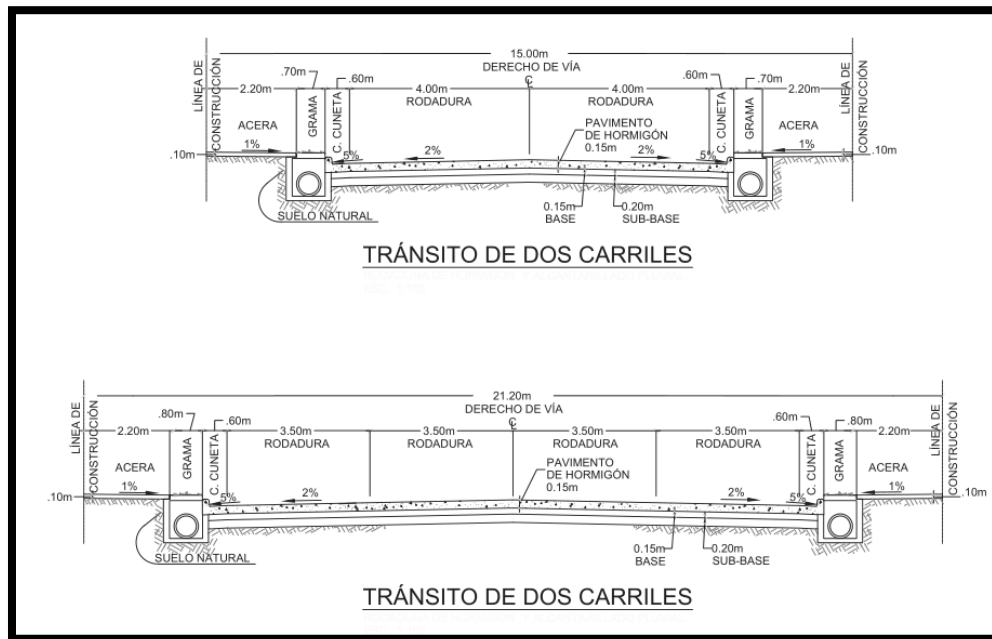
Planta vial servidumbre de 15.00 y 21.20
